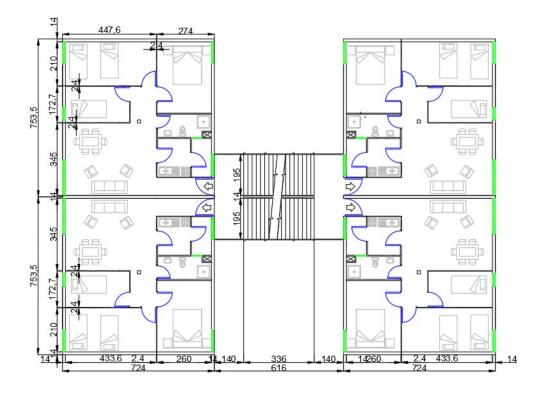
Planta arquitectura bloque habitacional de 4 deptos por planta, Villa Fundación, replicada en AutoCAD. Fuente: Elaboración propia.
